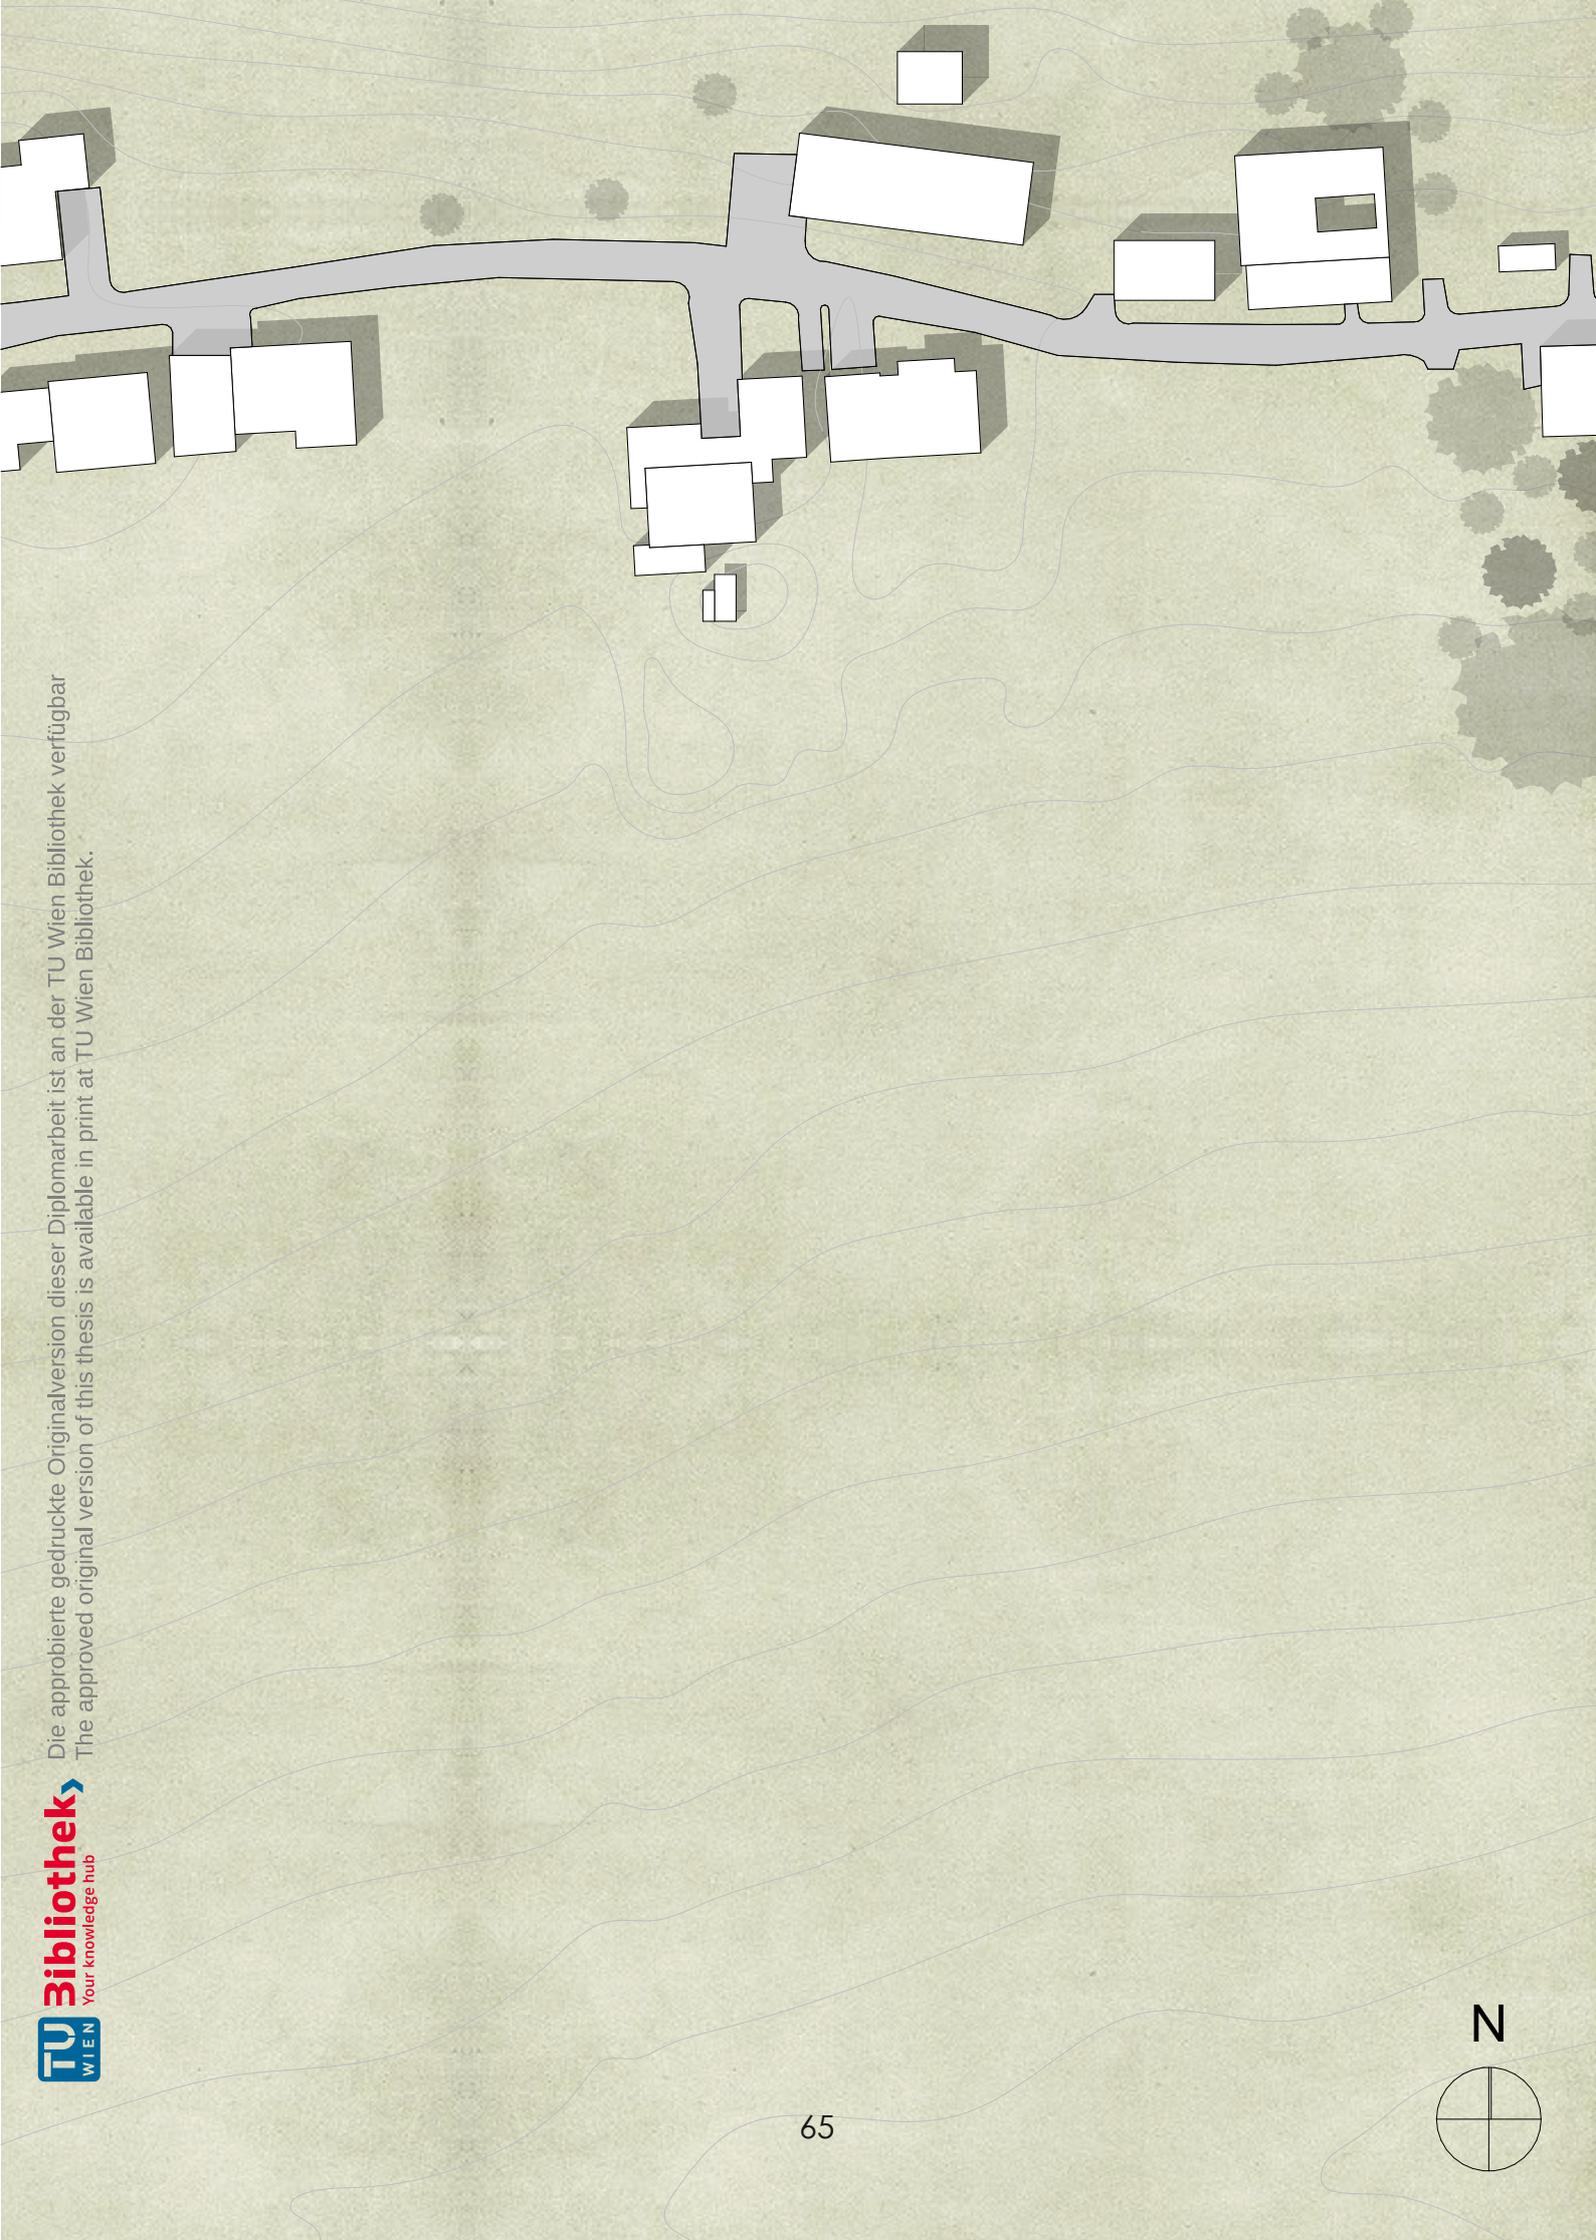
Lageplan Egg 1:1000 [eigene Darstellung]
